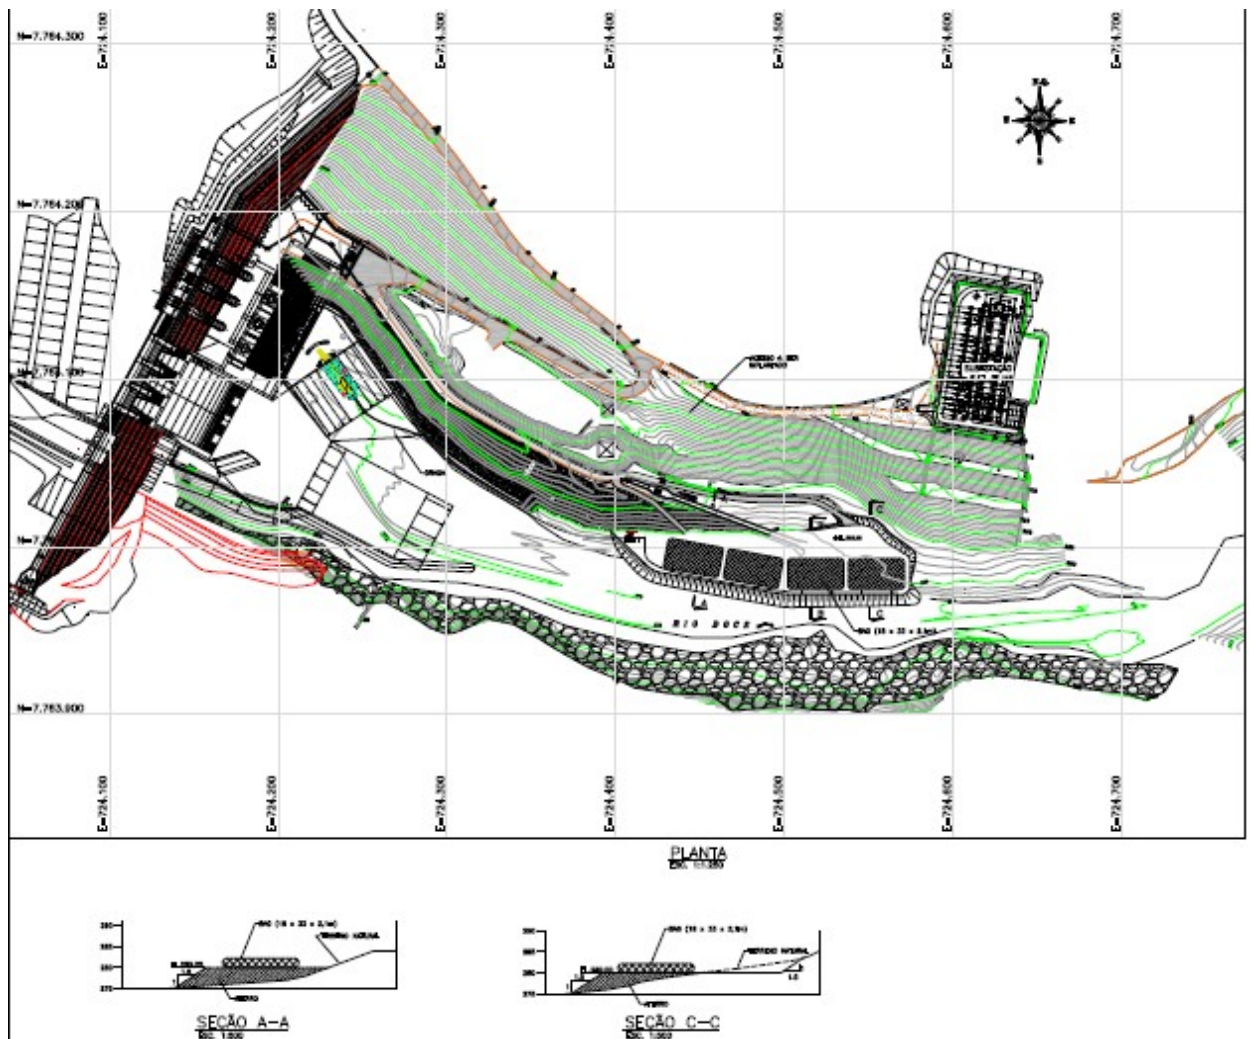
Planta – Dragagem do Canal de Fuga – Vista Geral
